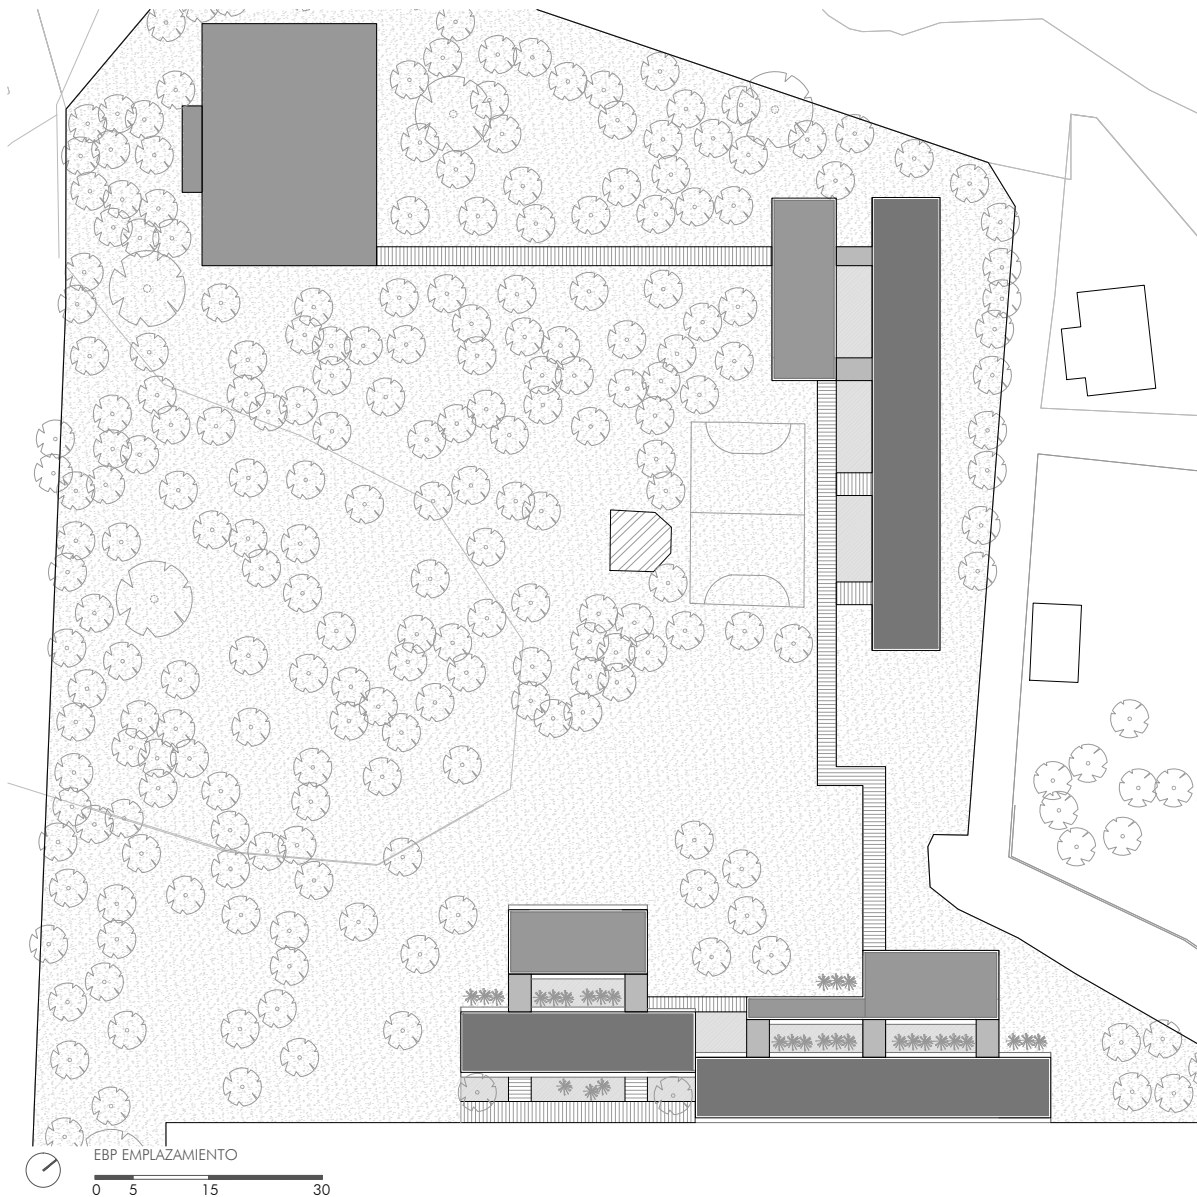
Colegio La Pureza de María, planta baja y esquema de implantación. F: Redibujo, AMM.
